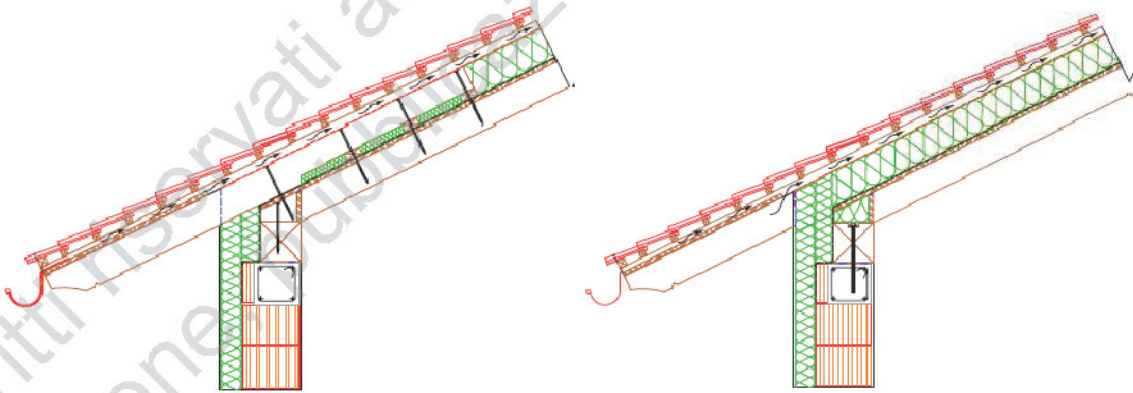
particolare costruttivo nella zona di intersezione con il setto verticale.
